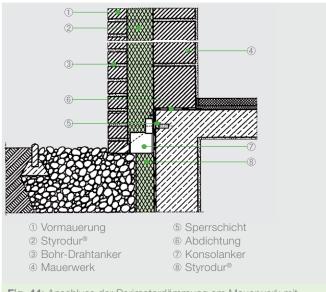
Anschluss der Perimeterdämmung am Mauerwerk mit Kerndämmung mit Konsolanker.
